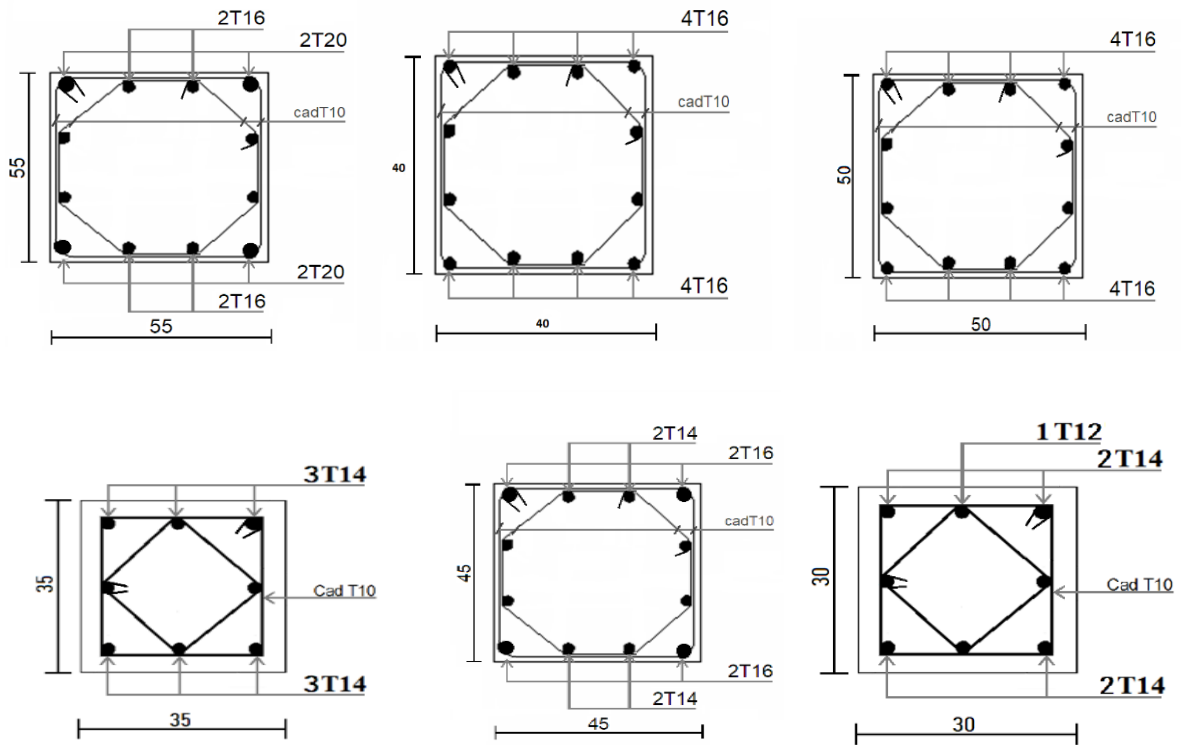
Ferrailage des poteaux en Zone IIa.
